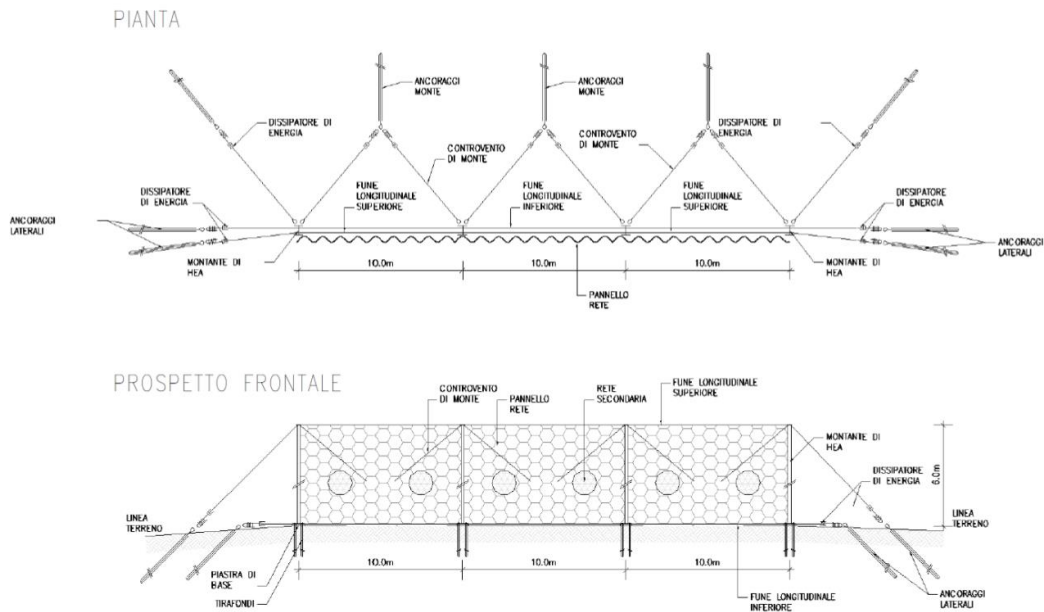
Imbocco Nord Scaleres – Barriere paramassi - pianta e prospetto
